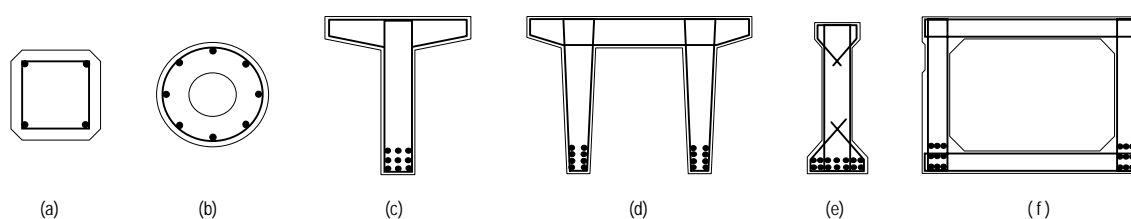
Exemplos de seções de peças com armaduras pré-tracionadas: *a*) estaca ou poste de seção quadrada; *b*) estaca ou poste de seção circular oca (podem ser fabricados por centrifugação do concreto); *c*) viga T simples, usada em construção civil; *d*) viga T dupla, usada em construção civil; *e*) viga I para pontes; *f*) viga celular para pontes.
